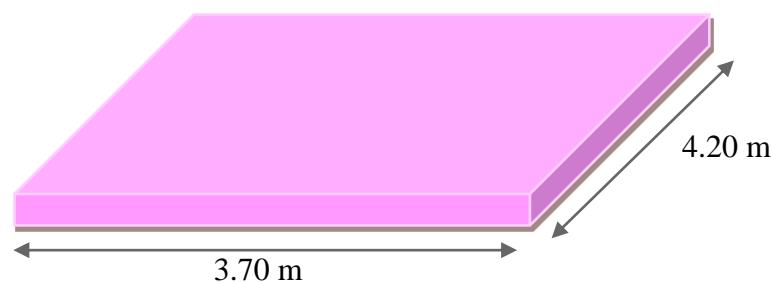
Les dimensions du plancher le plus sollicité.
